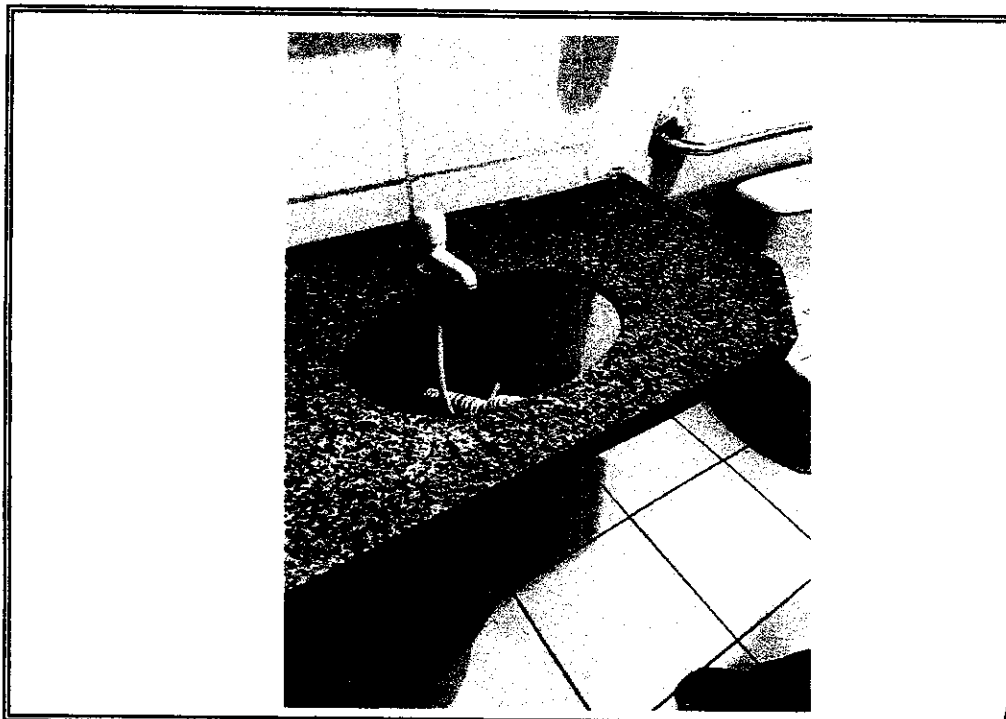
INSTALACAO HIDRAULICA-PIA SEM CUBA
